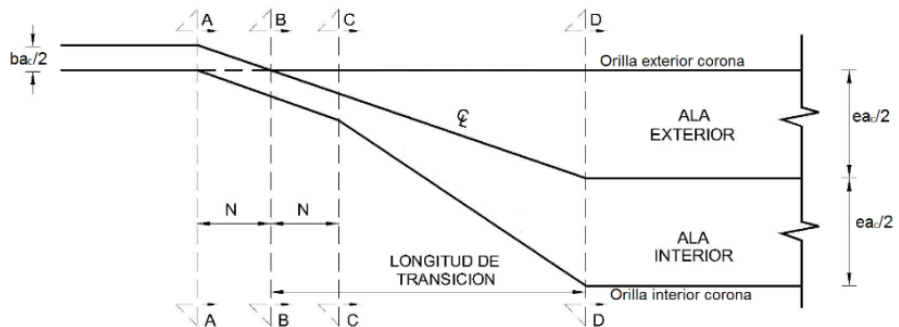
Transición de sobreelevación con giro sobre orilla
